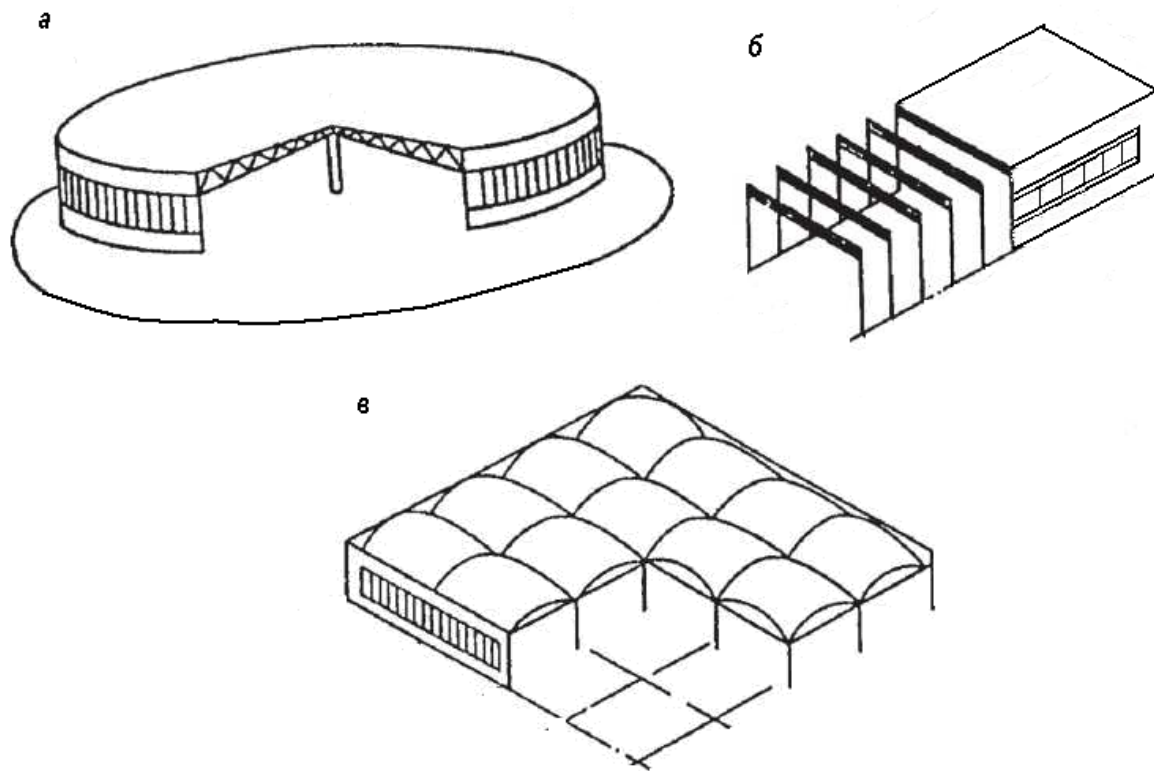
Одноповерхові виробничі будівлі: а – зального типу з центральною опорою; б – зального типу без проміжних опор; в – коміркові
